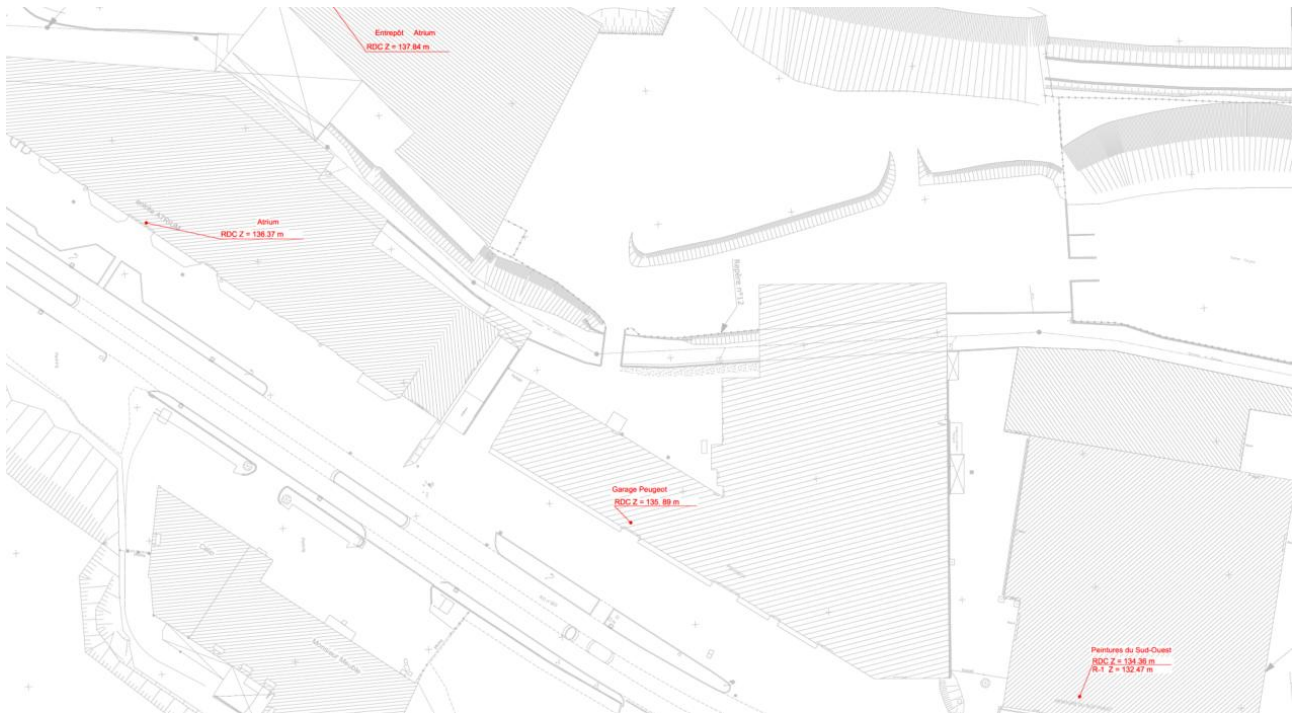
Relevé cotes plancher - Secteur ATRIUM et PEUGEOT
